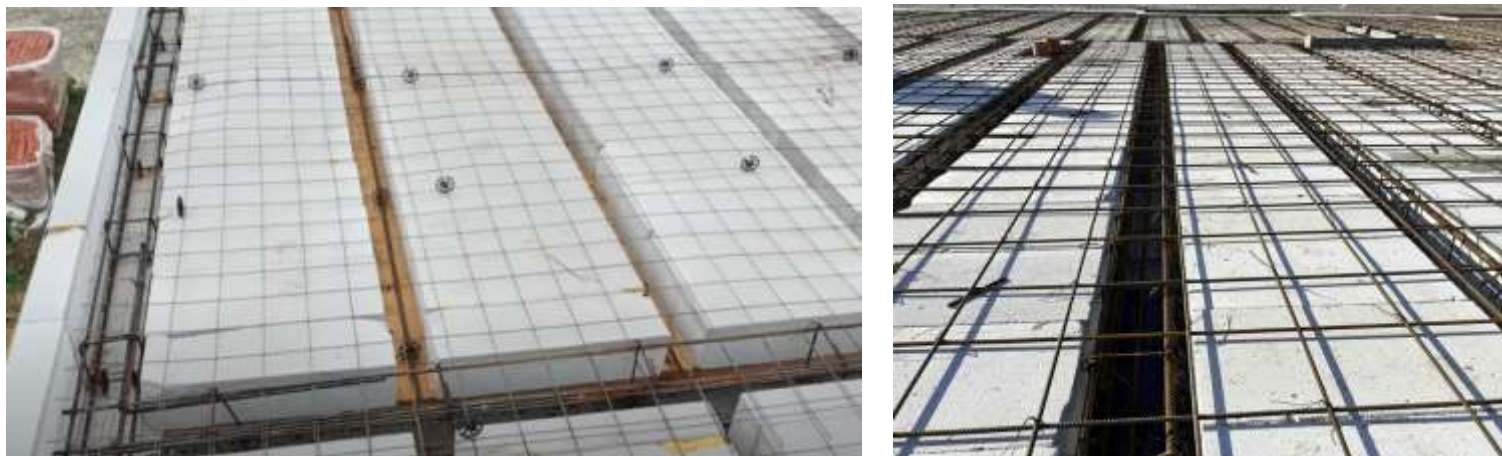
Раскладка газоблоков на перекрытие с запениванием
